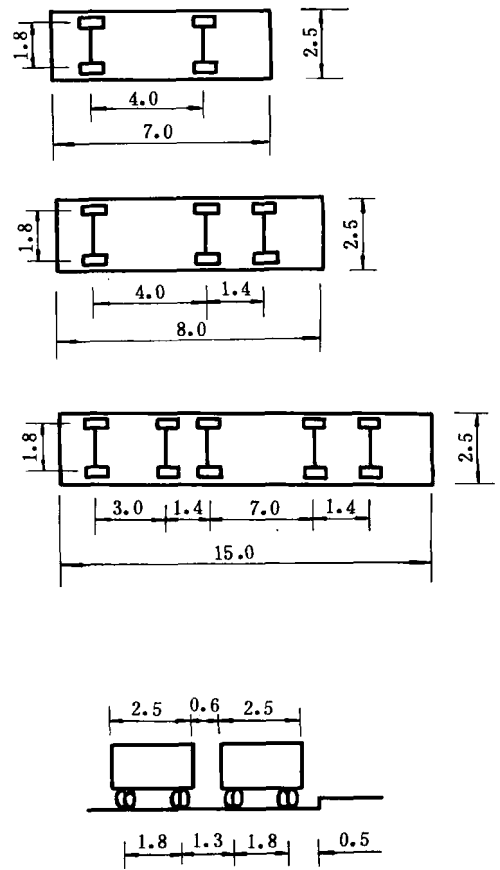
各种设计车辆的平面尺寸和横向布置图 (尺寸单位,m)
